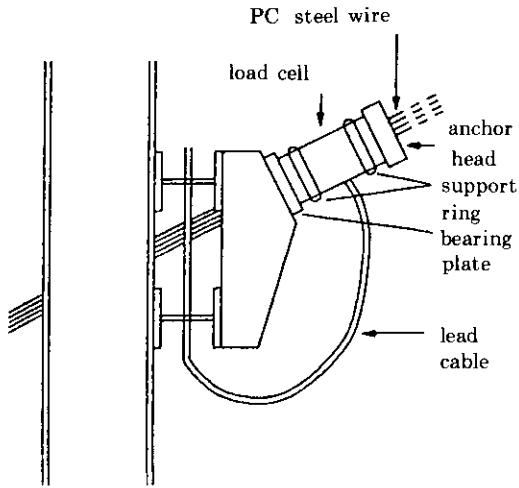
earth anchor 하중측정용 load cell 설치상세도
